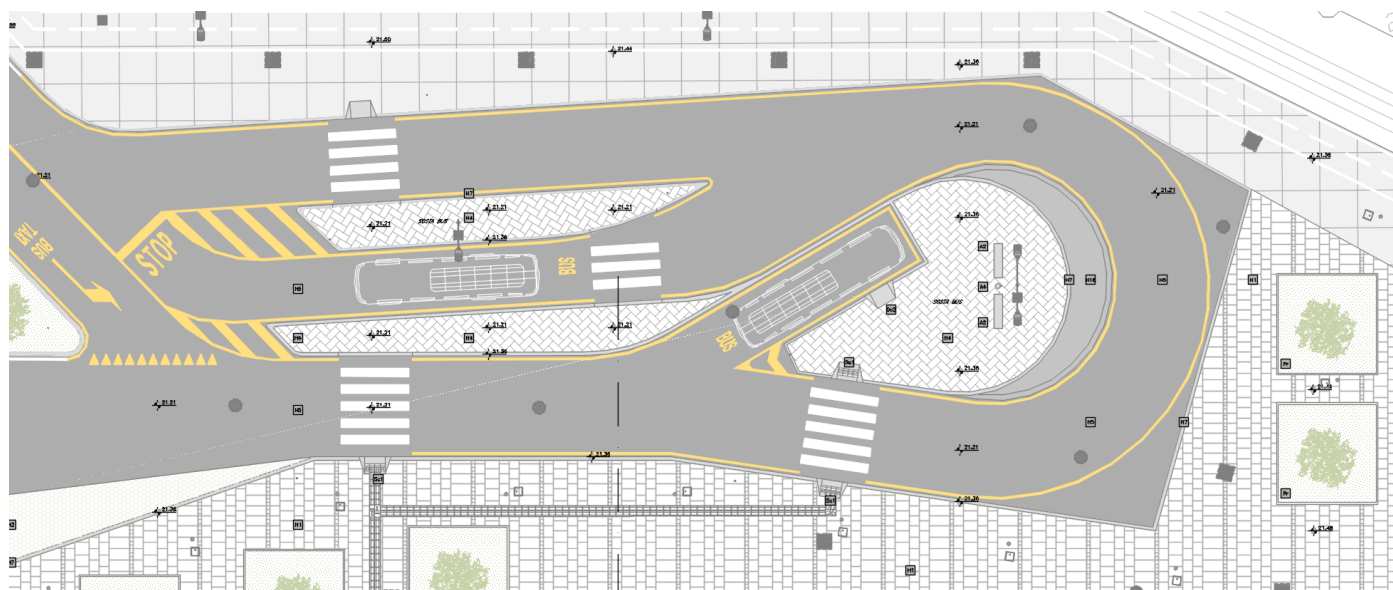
Stralcio sistemazione esterna – progetto esecutivo
